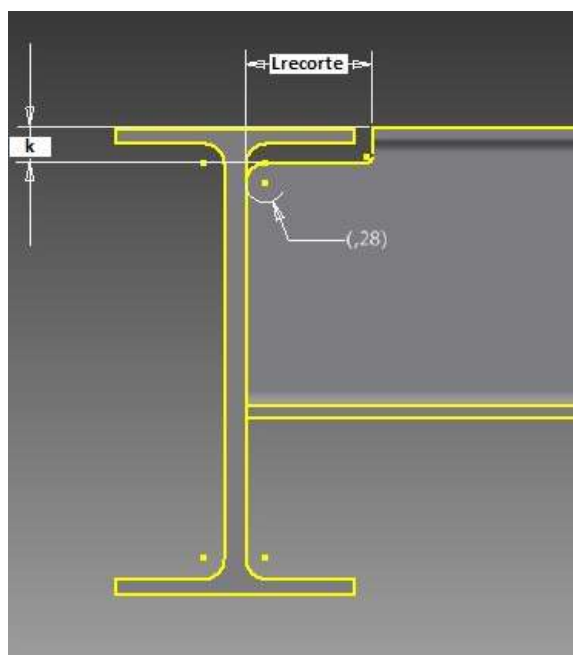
RECORTE DE VIGA O DESPATINAMIENTO
